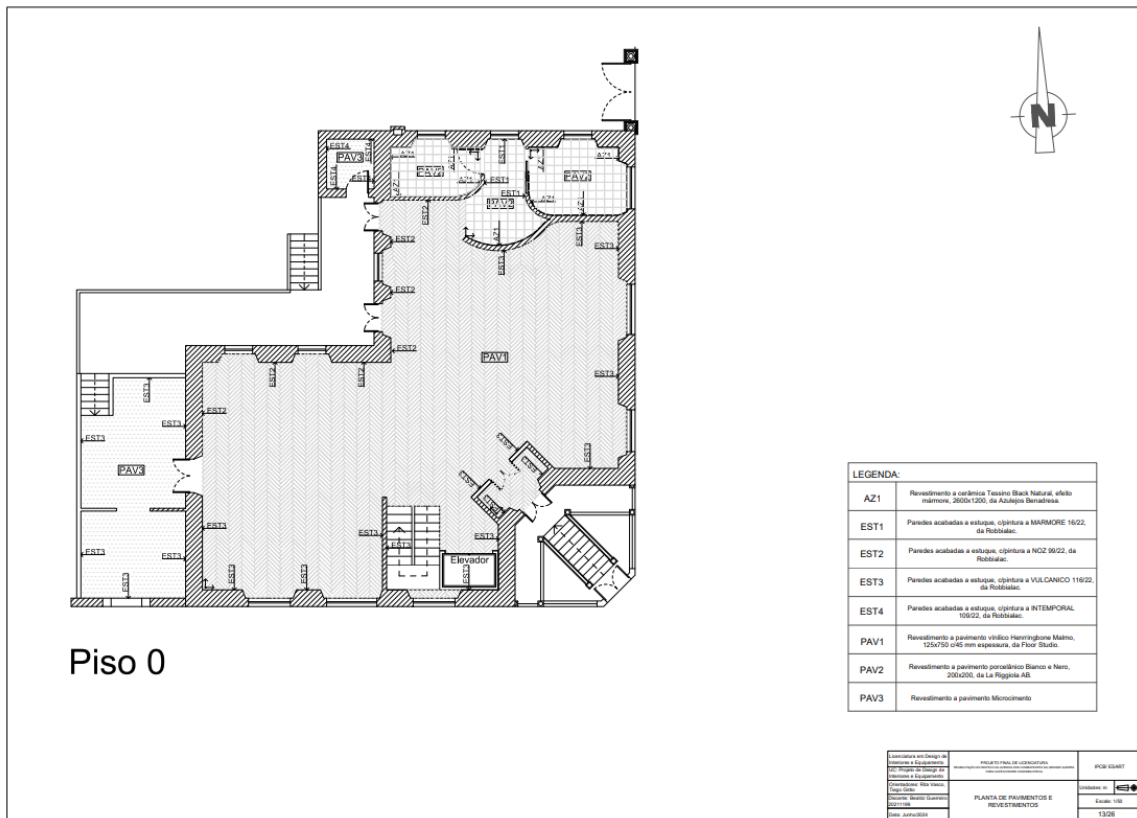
Planta de Pavimentos e Revestimentos, piso 0, sem escala. Fonte: Autor
